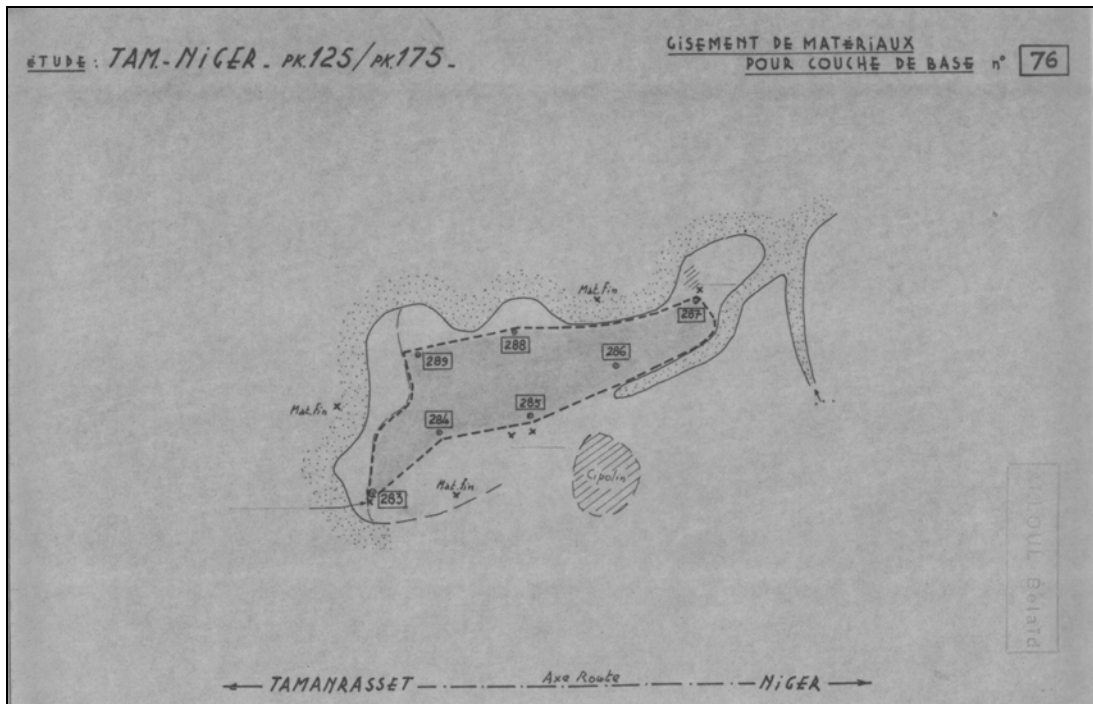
Plan d'une carrière de matériaux de chaussée sur la transsaharienne (Etude LNTPB : Mr Domec)
